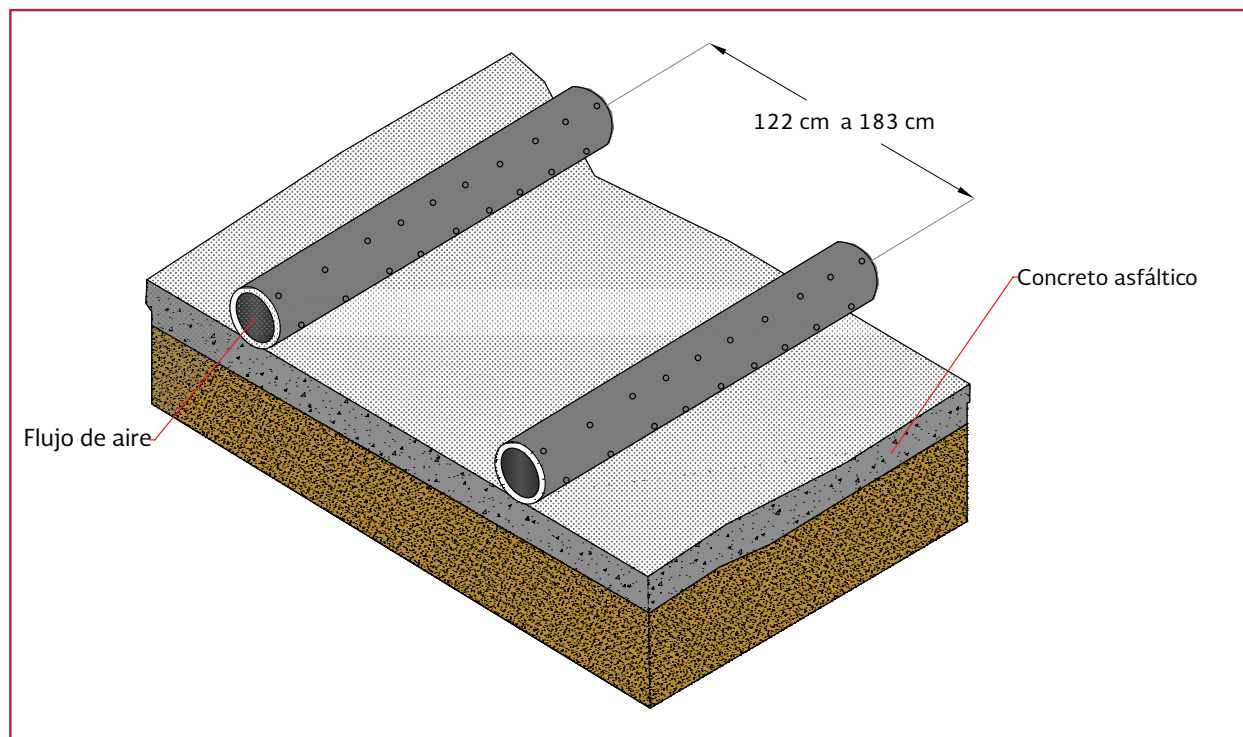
Tuberías enterradas y perforadas en la base de concreto
